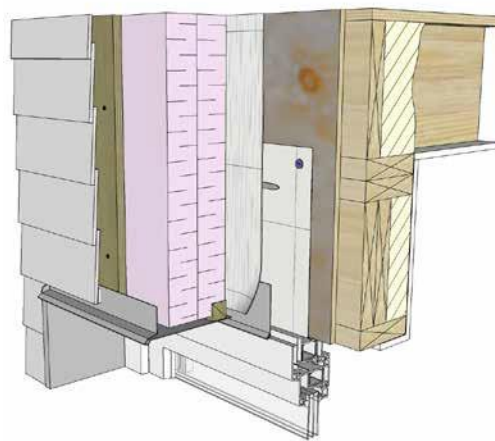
Solin de tête de fenêtre installé sur la face avant du lattage avec solin secondaire installé directement sur la fenêtre
